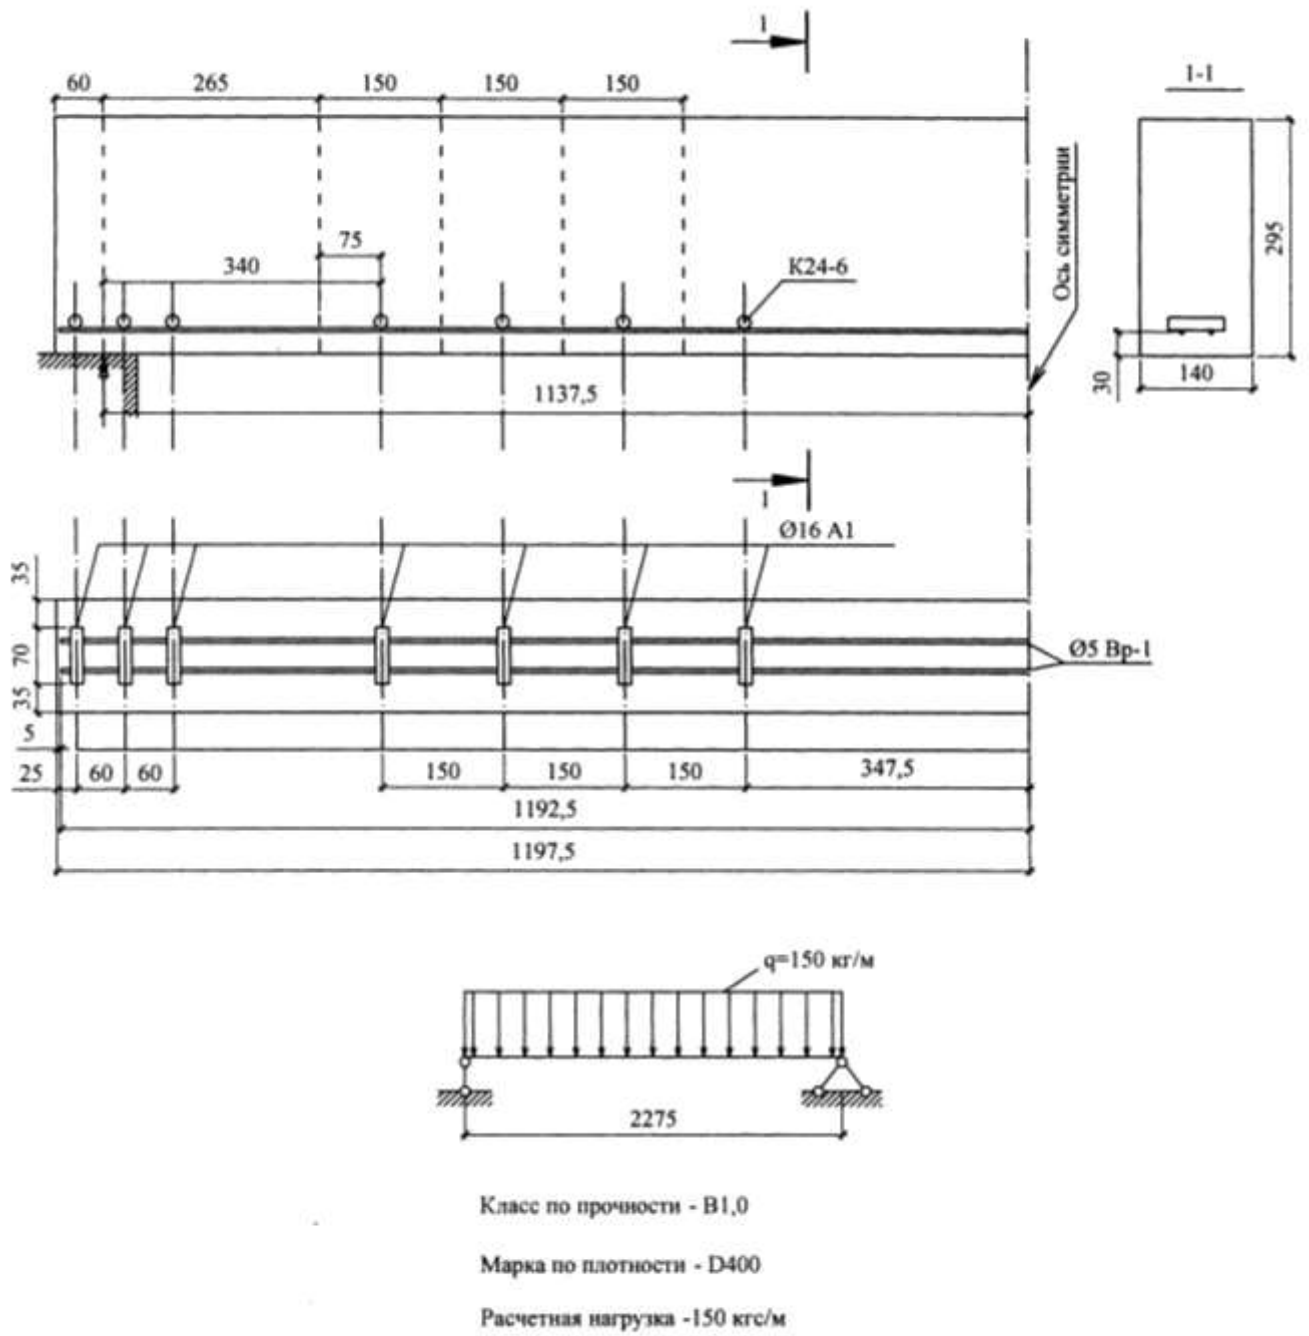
Армирование и расчет перемычки СБП-240П/150Б
